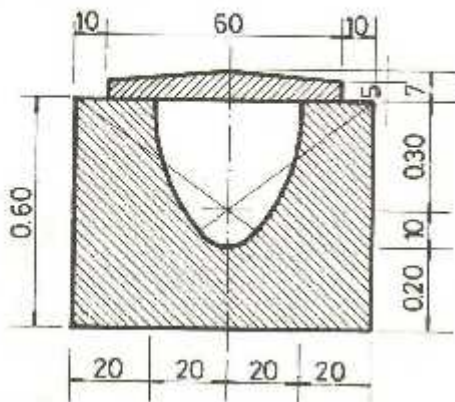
Kanal za kablove za tipove tunelskih konstrukcija na pruži Beograd-Bar
